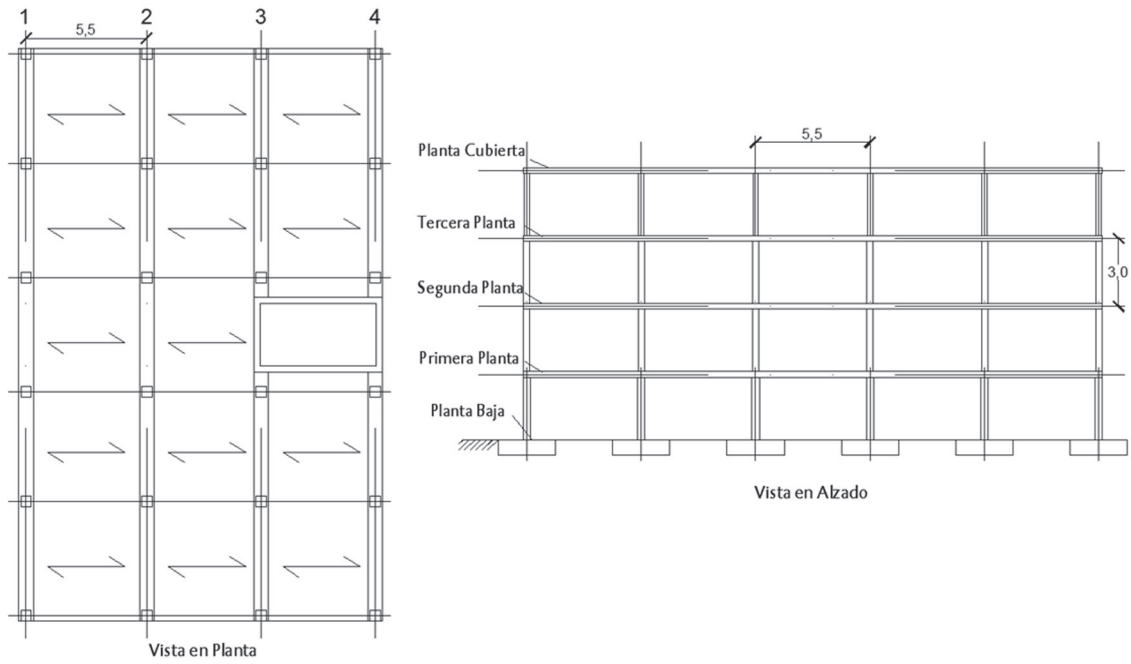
Planta tipo y alzado de uno de los pórticos del edificio.
